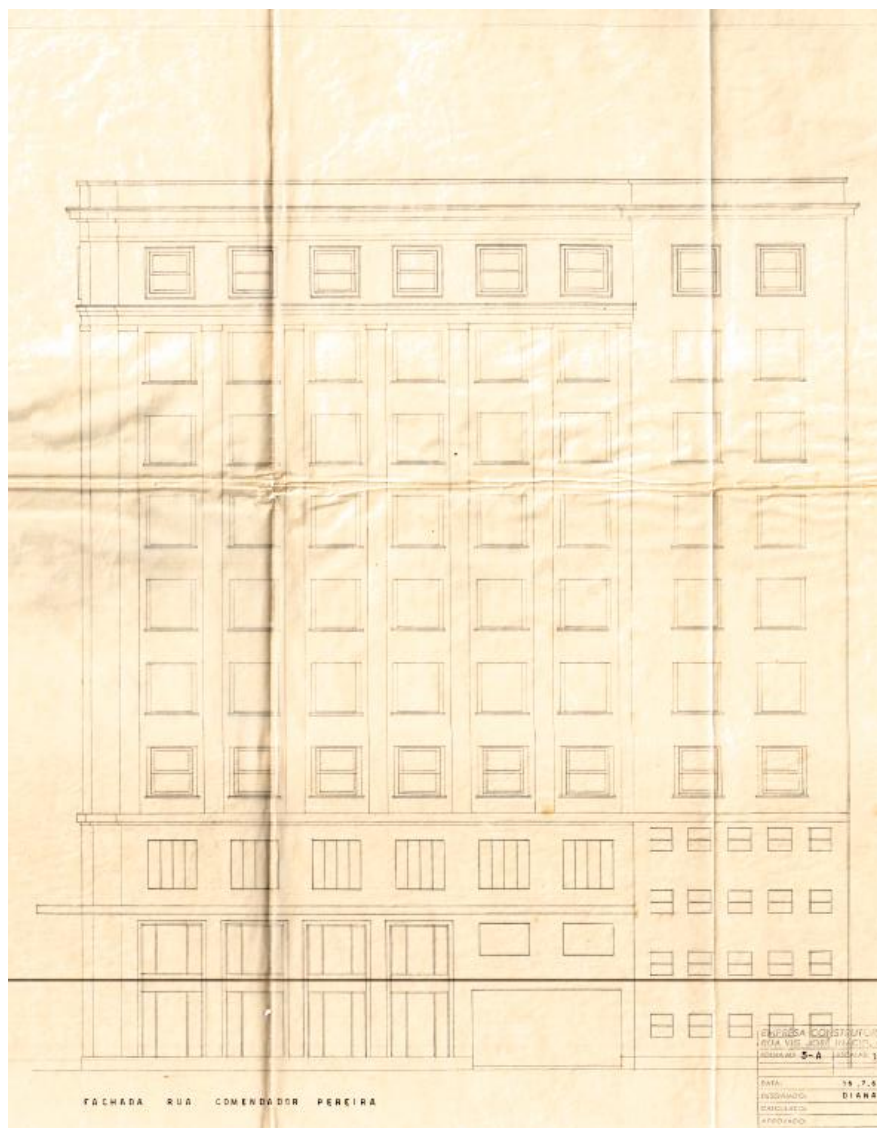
Fachada R. Com. Manoel Pereira original (1950).
